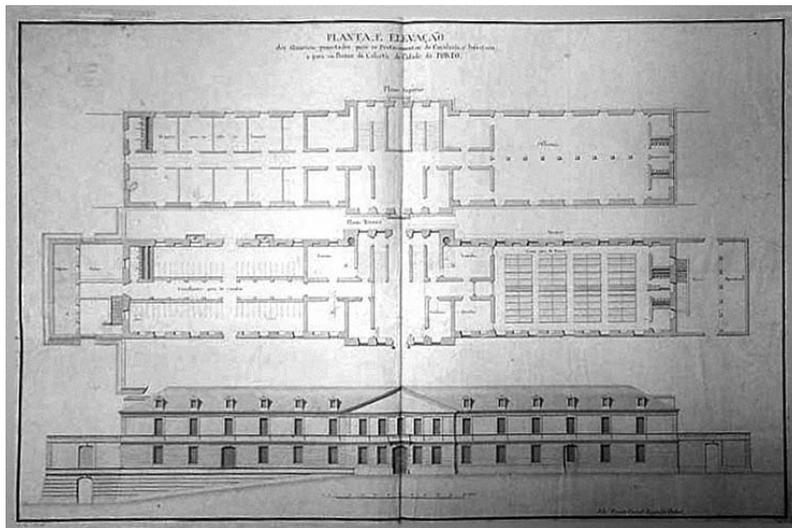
Plano da Real Casa Pia do Porto assinado por Teodoro de Sousa Maldonado
